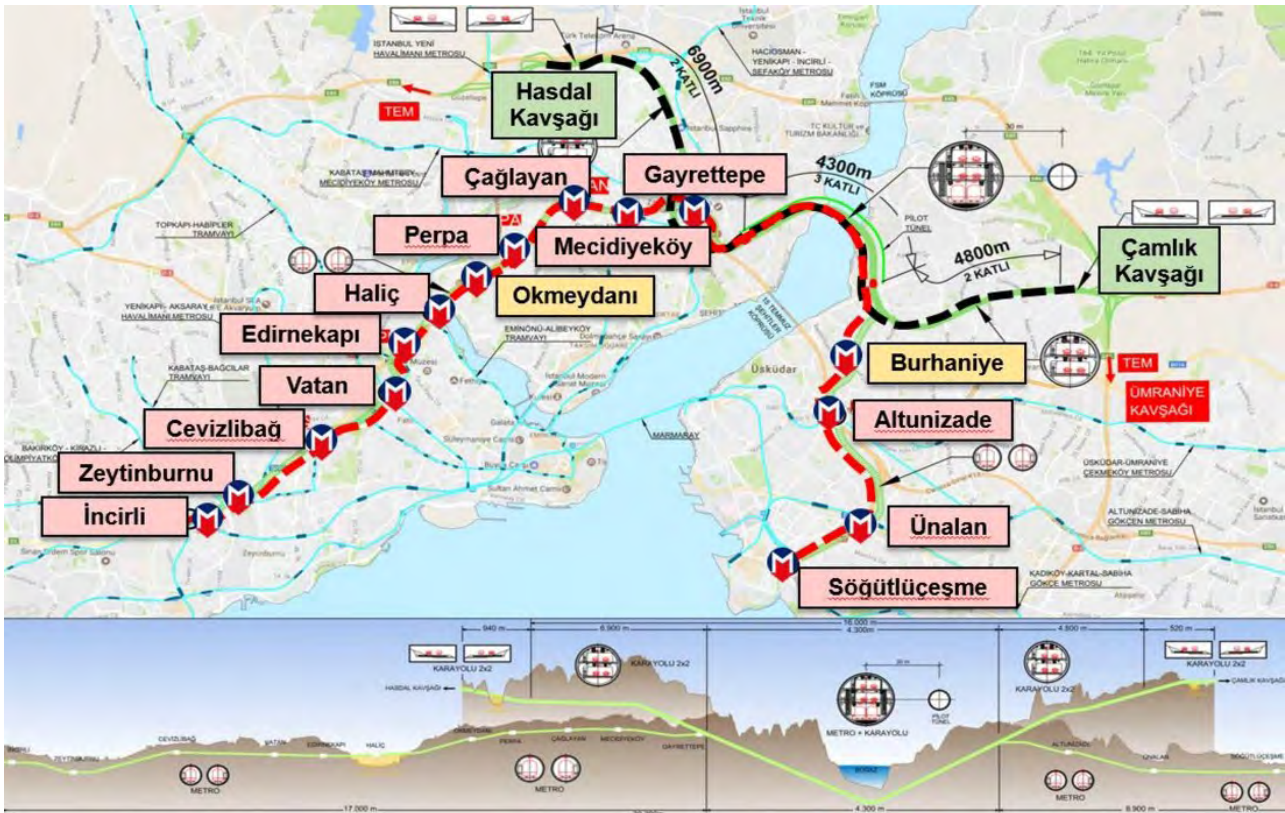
Grande Tunnel di Istanbul – Tracciato planimetrico e altimetrico
